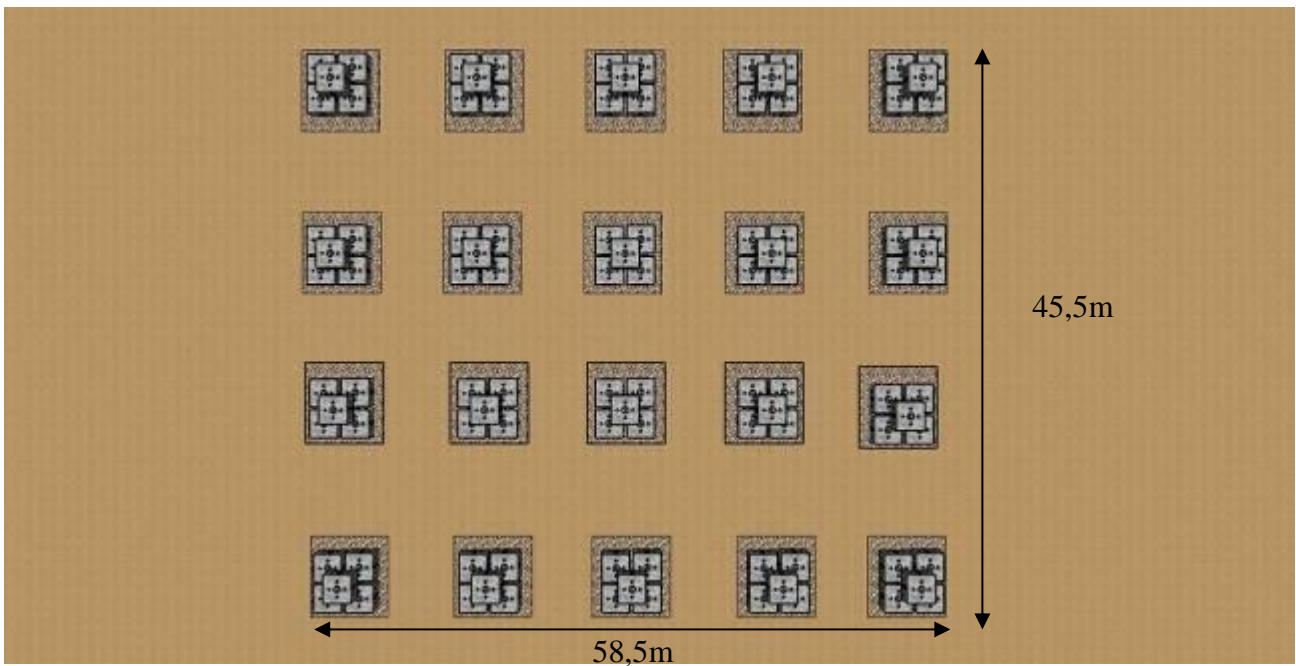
Planimetria delle strutture costituenti il lotto centrale di intervento
